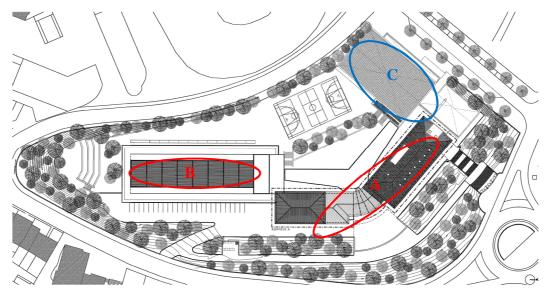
Escola Secundária Abade de Baçal | Layout plan (post-intervention)
